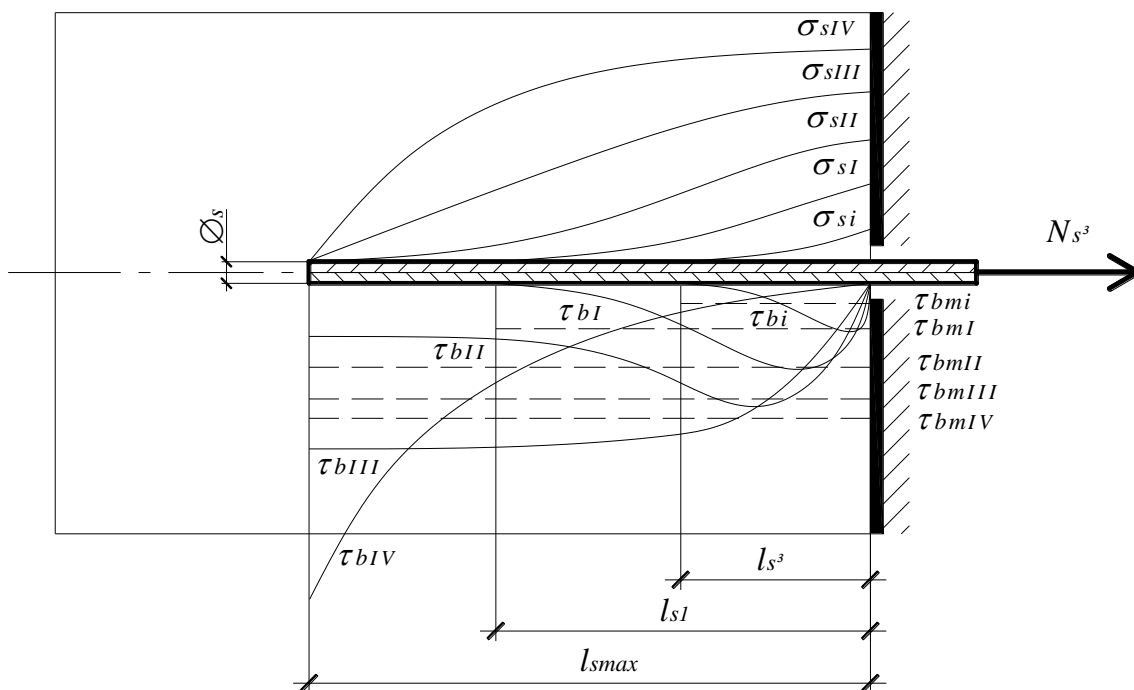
Схема зміни напруженого стану контактної шару бетону та арматурного стрижня при висмикуванні його з бетону
